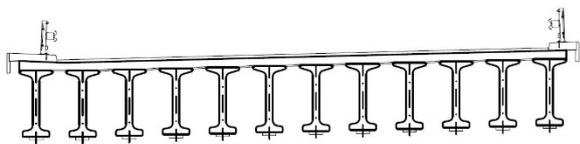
Sección transversal típica de puente de vigas en Eslovaquia.
